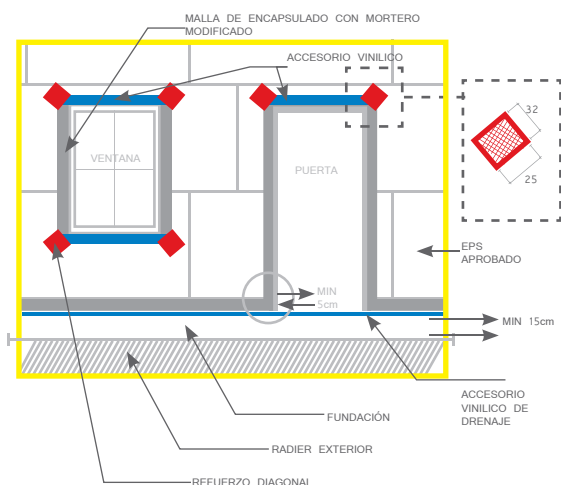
m: Disposición de refuerzos en esquinas en sistema EIFS con drenaje, (elevación).
